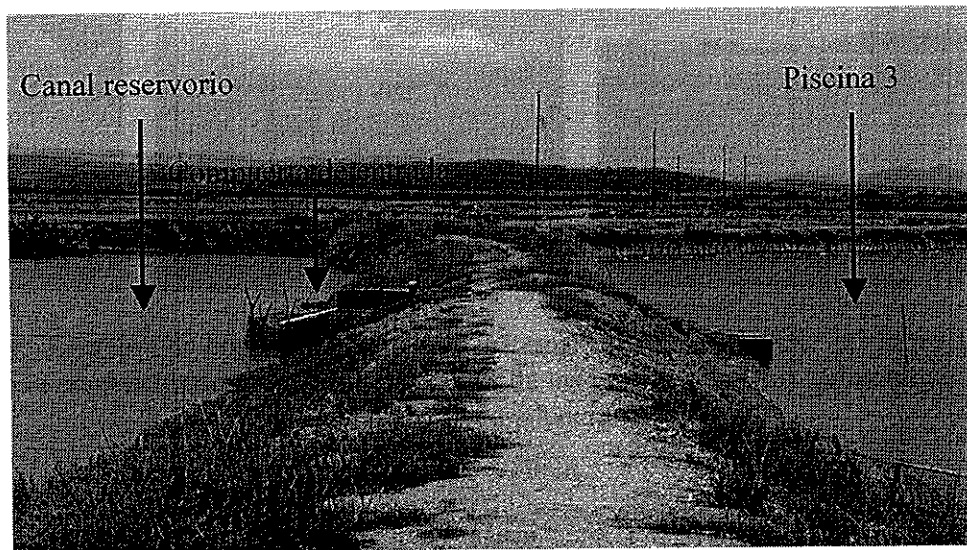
Estado del muro entre el canal reservorio y la piscina 3 al momento de la compra de la camaronera COFIMAR.
